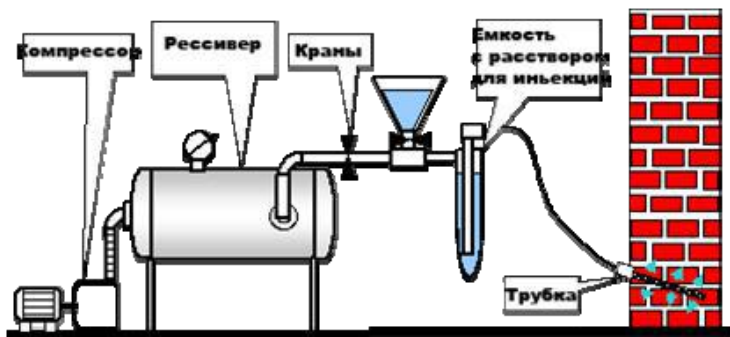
Схема оборудования для инъекций в стену изоляционных растворов
